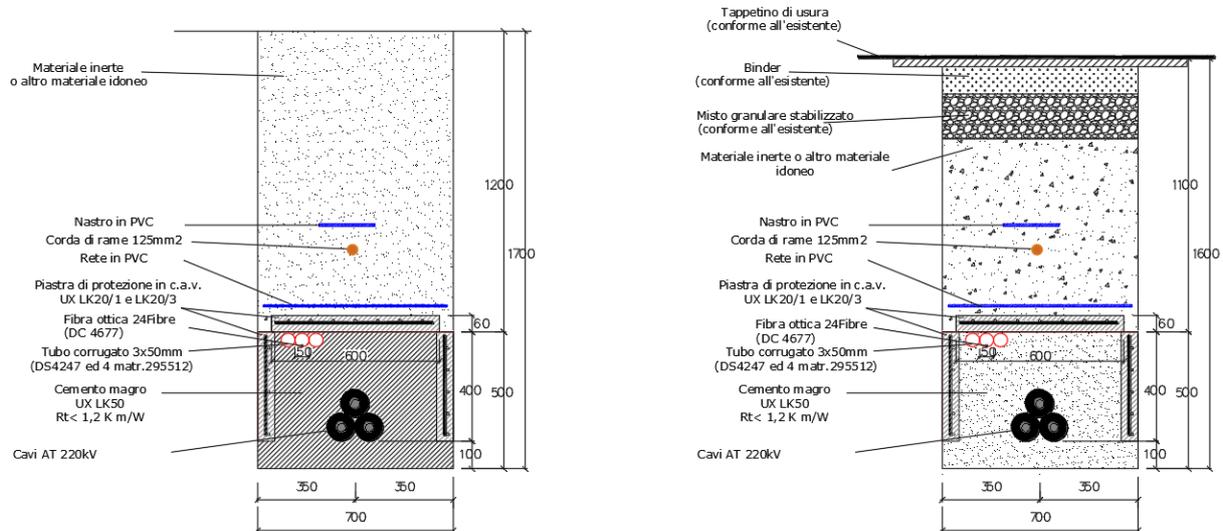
Tipico di sezione cavidotto AT su strada e su terreno agricolo
